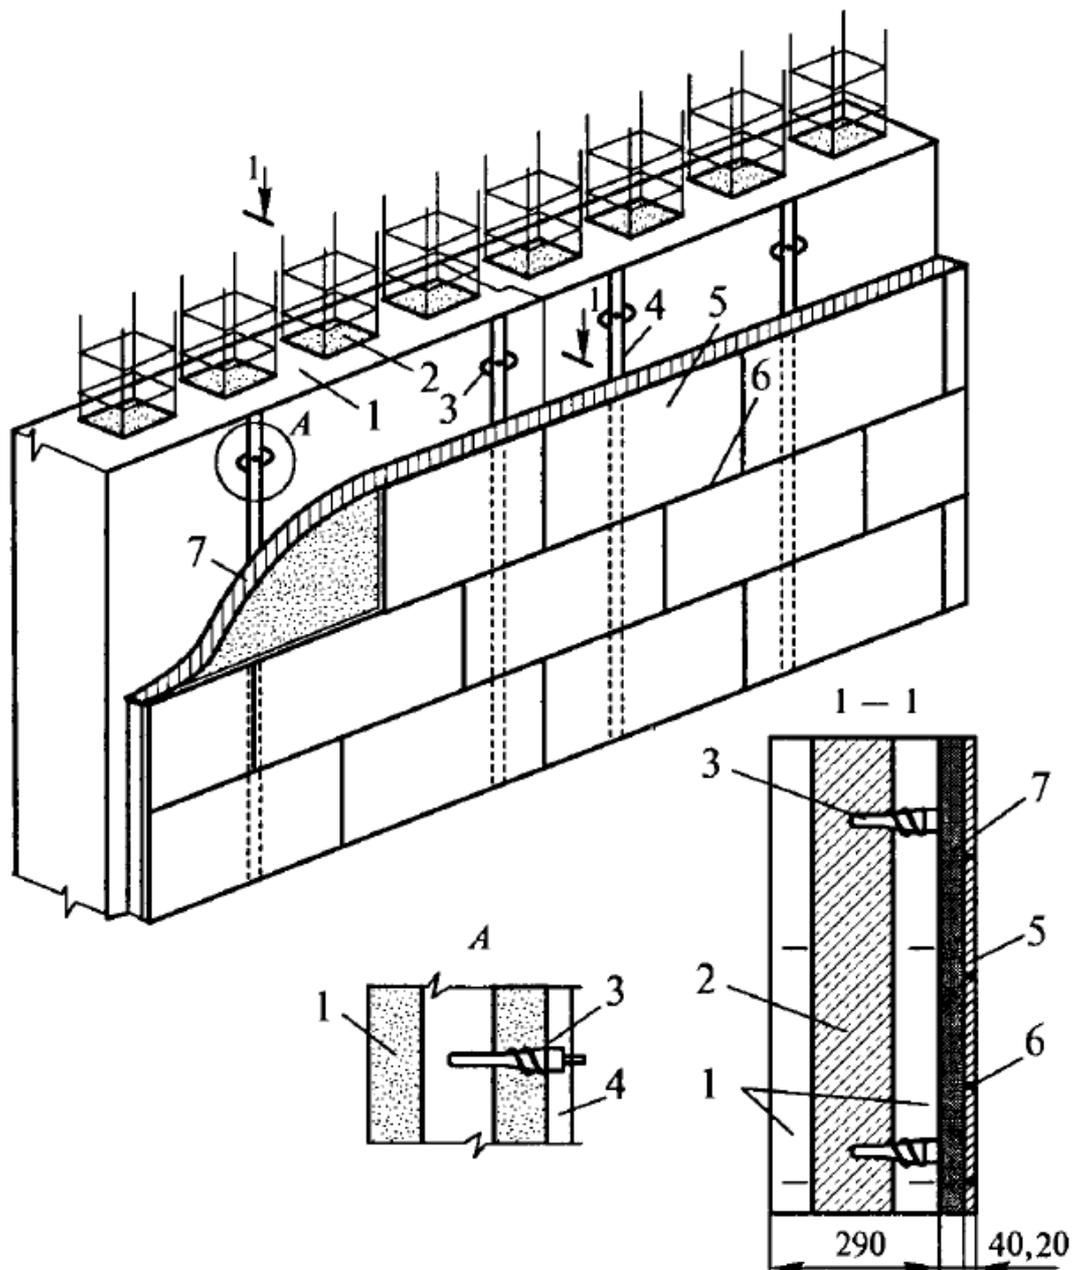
б. Схема облицовки стен, возводимых в несъемной опалубке:
